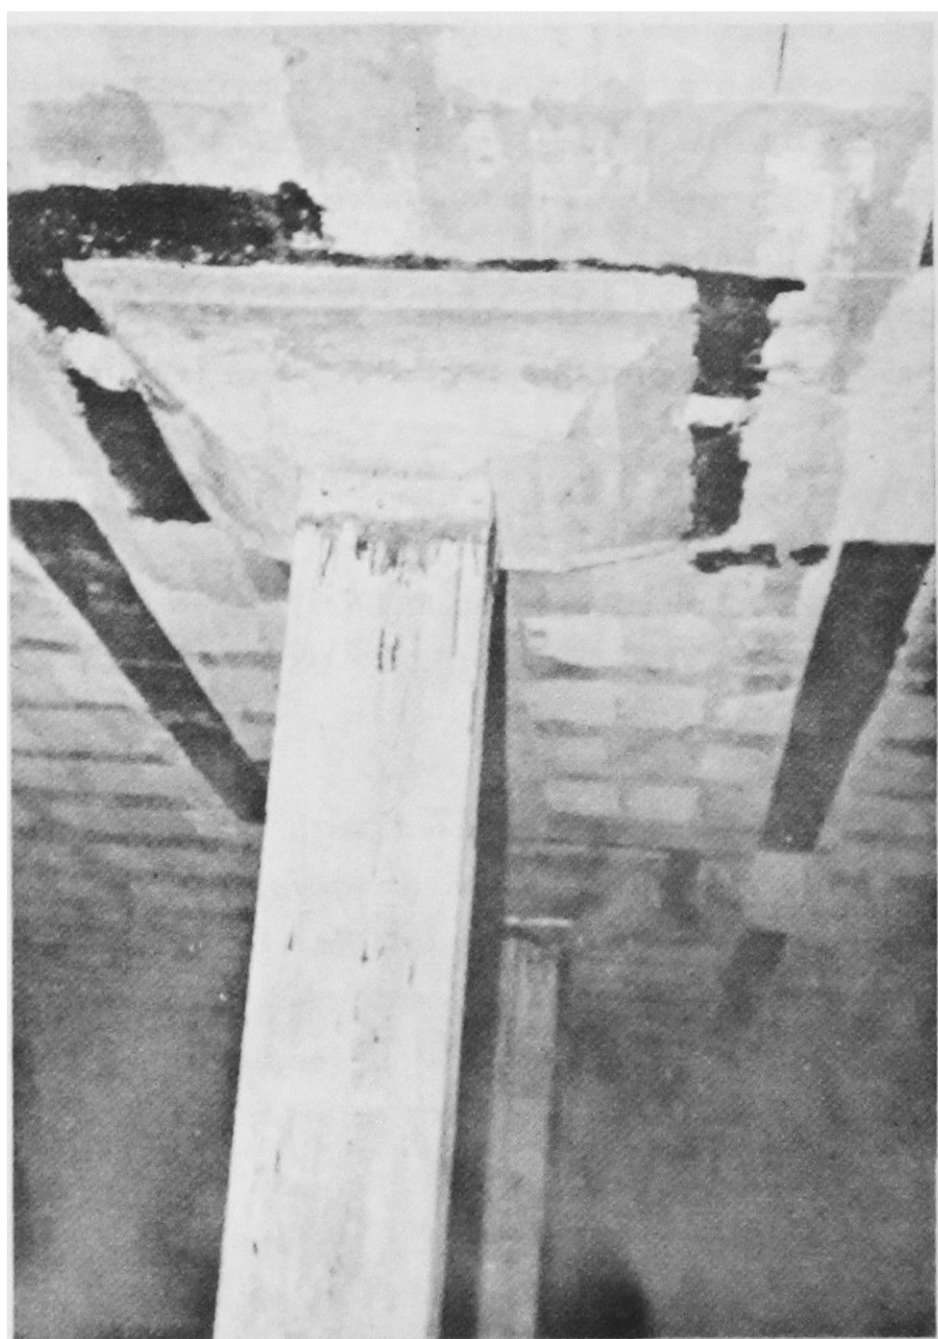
Capitel de hormigón unido a un pilar y a un forjado de piso, mediante resinas epoxi, para evitar el efecto de punzonamiento. Al fondo se aprecian bandas de acero pegadas con las mismas resinas al forjado para aumentar su capacidad resistente.
